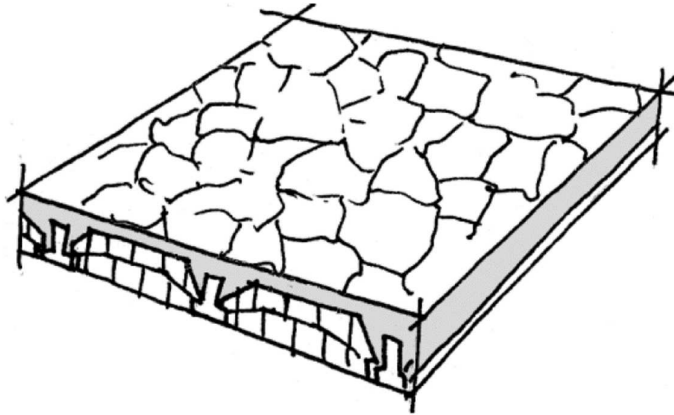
Fisuras provocadas por Afogado, fisuración en mapa (Fuente, MPE)
